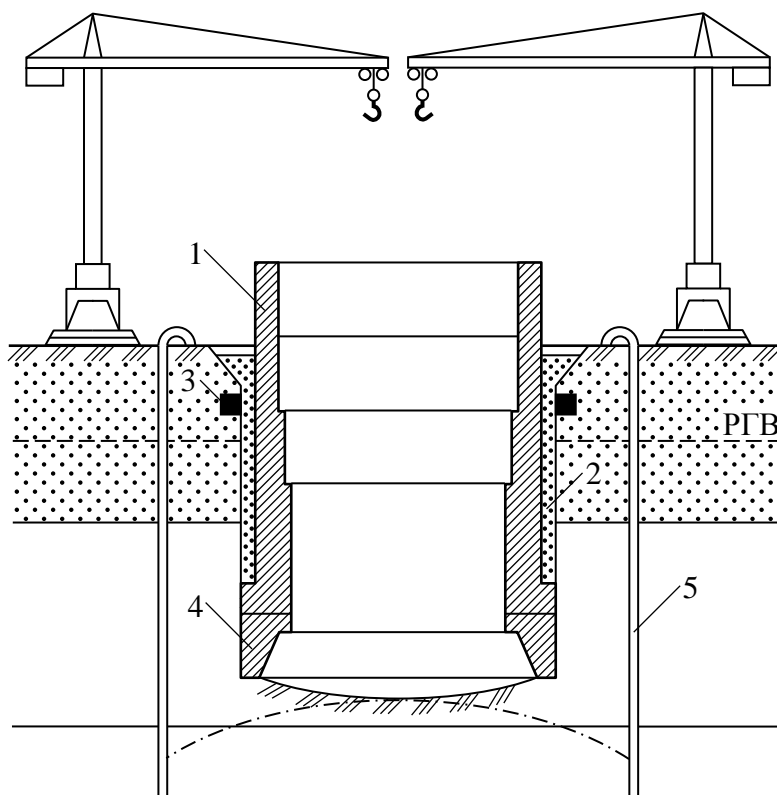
Масивний опускний колодязь із глибинним водозниженням:
